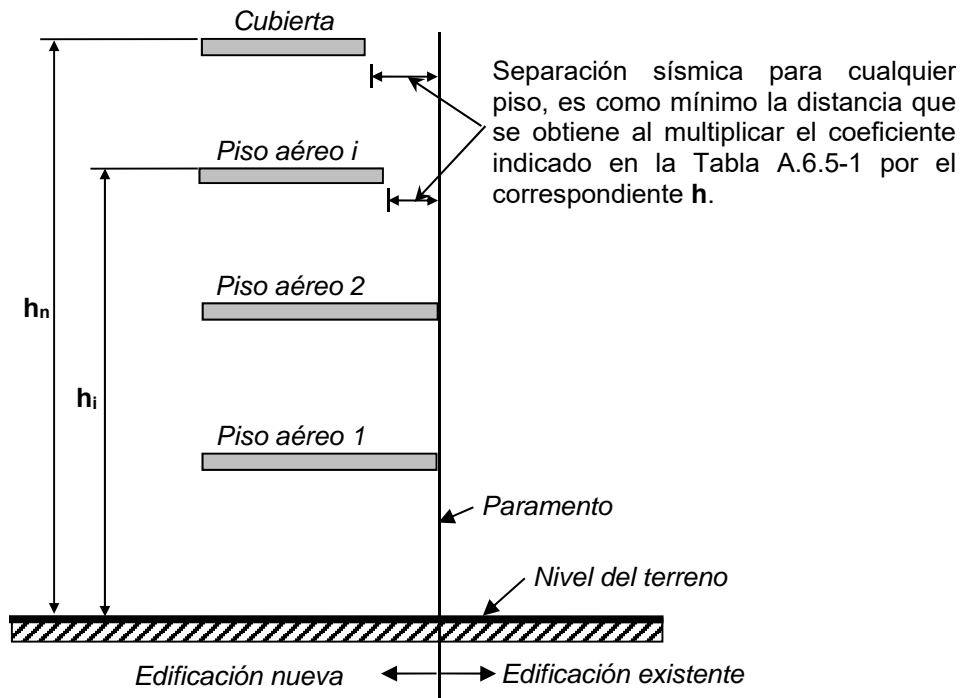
Medición de la separación sísmica (vista en elevación)
